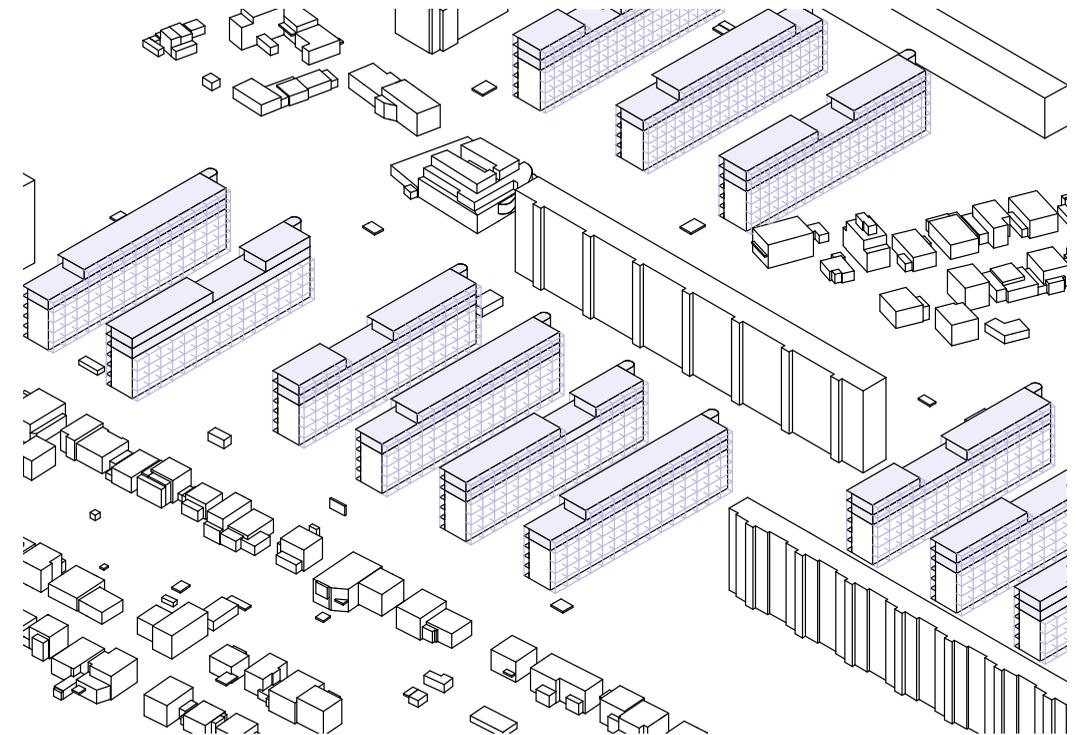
Transfermöglichkeit - Siebenbürgenstraße
